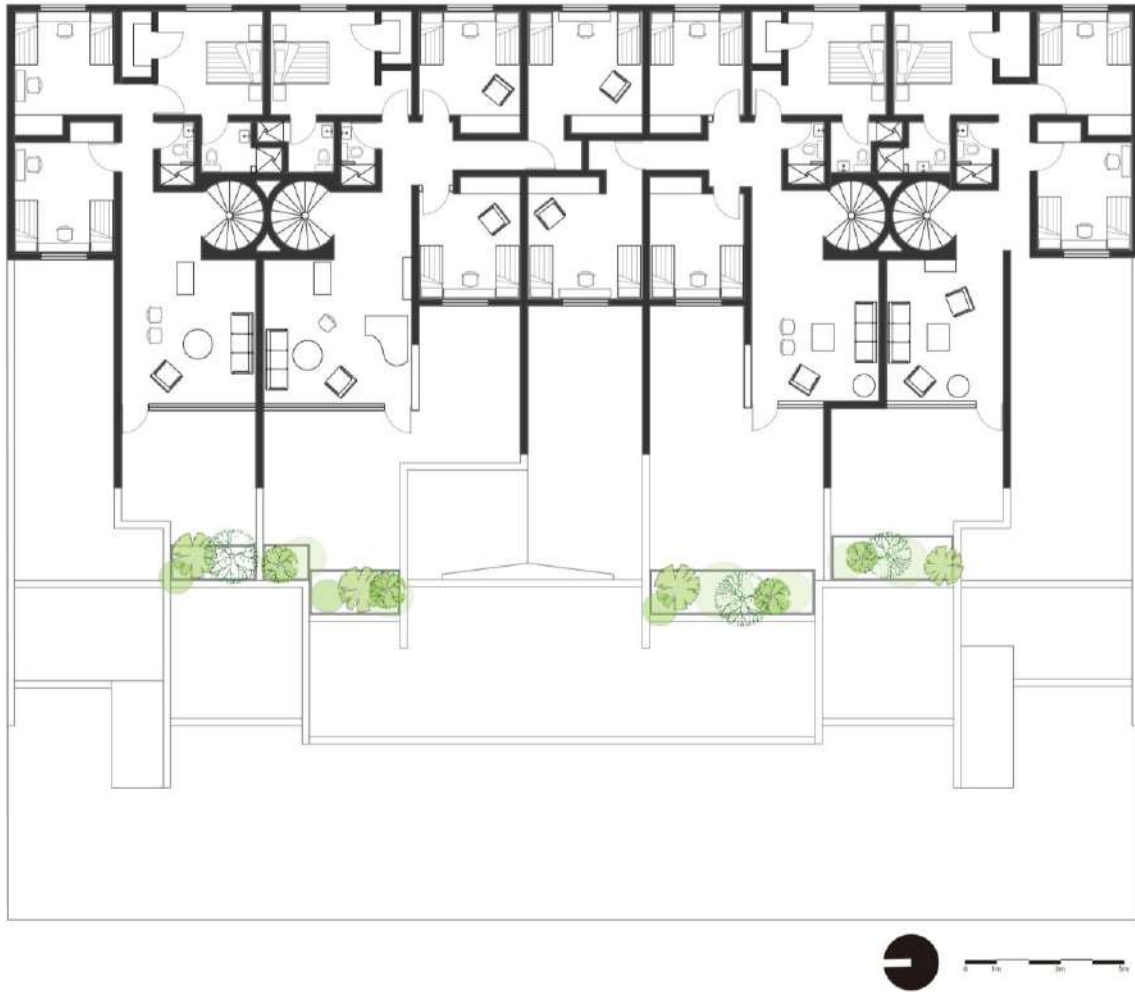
Planimetría Multifamiliar Escalonado Gerona, apartamentos tipo dúplex. Tomado de: Téllez, G. (2018).
